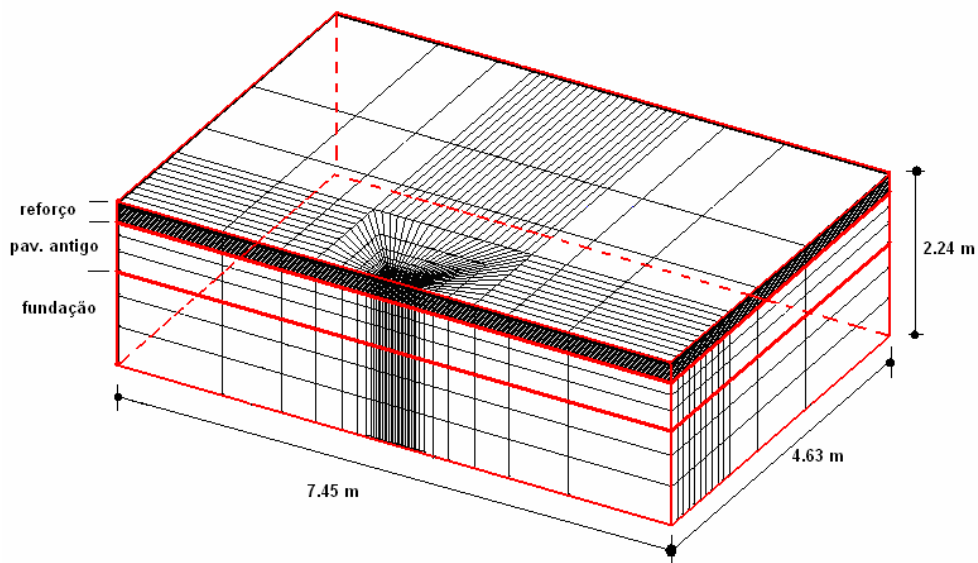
Dimensões do modelo mecânico do pavimento
